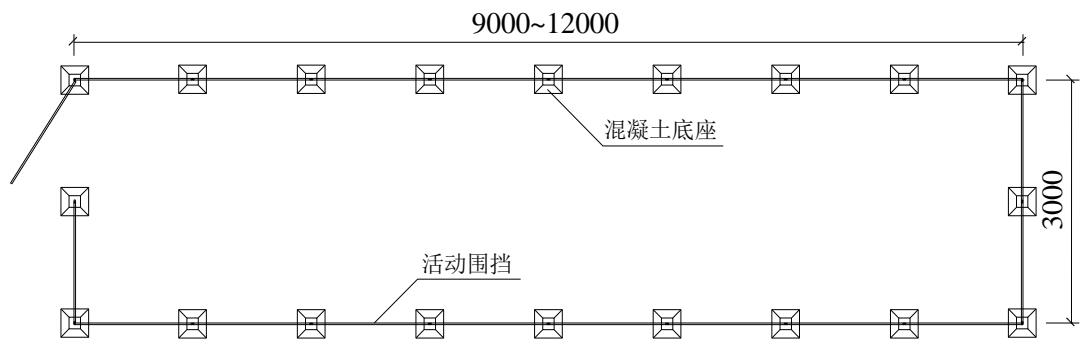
装配式围挡平面示意图 (单位: mm)
